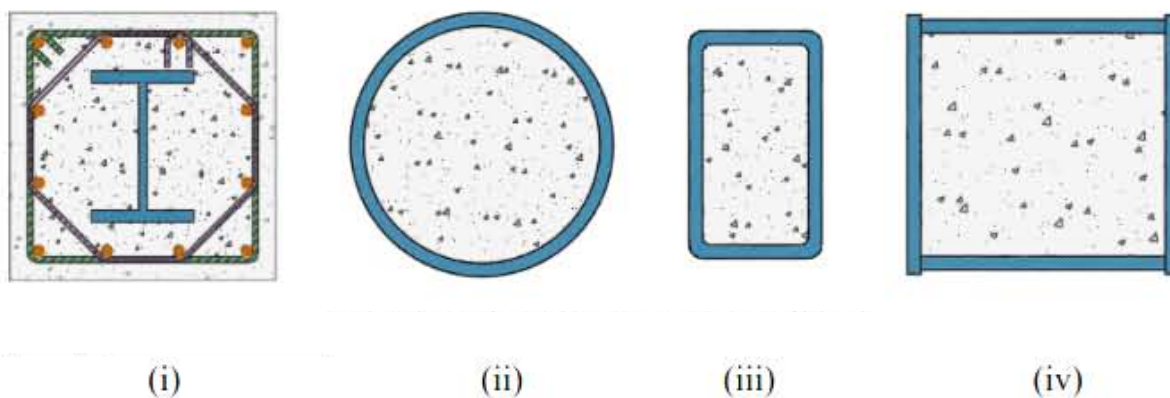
Secciones transversales de columnas mixtas de acuerdo a la NTC (acero) 2023.
